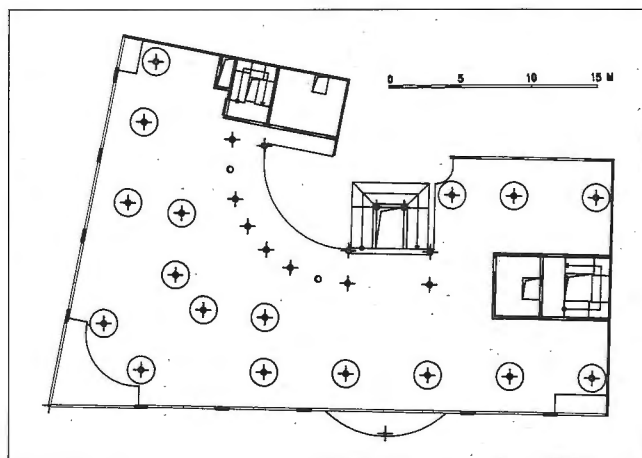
Konstrukce suterénu – technické zázemí a parking
